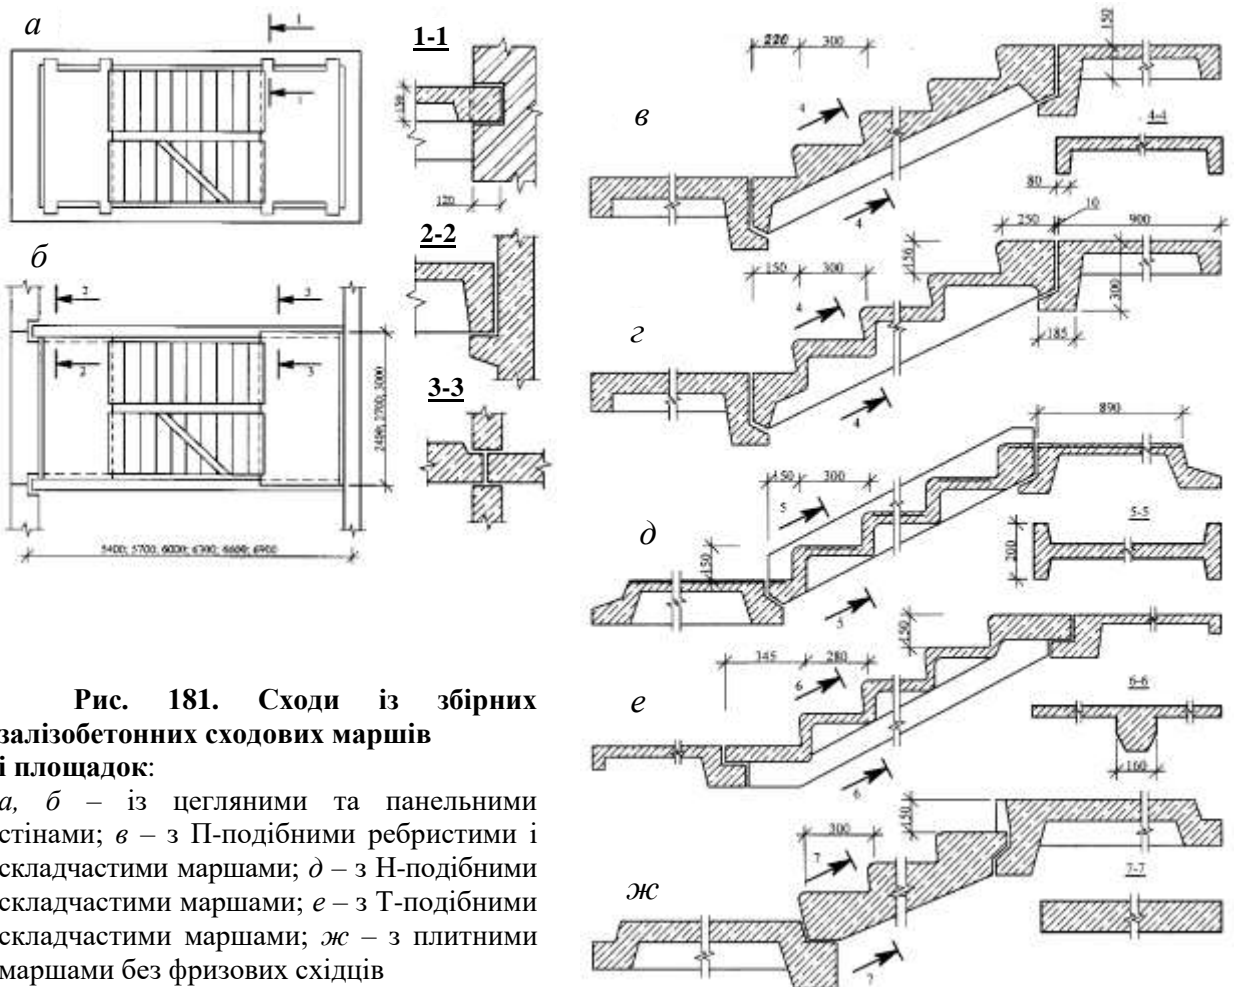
Сходи із збірних залізобетонних сходових маршів і площадок:
